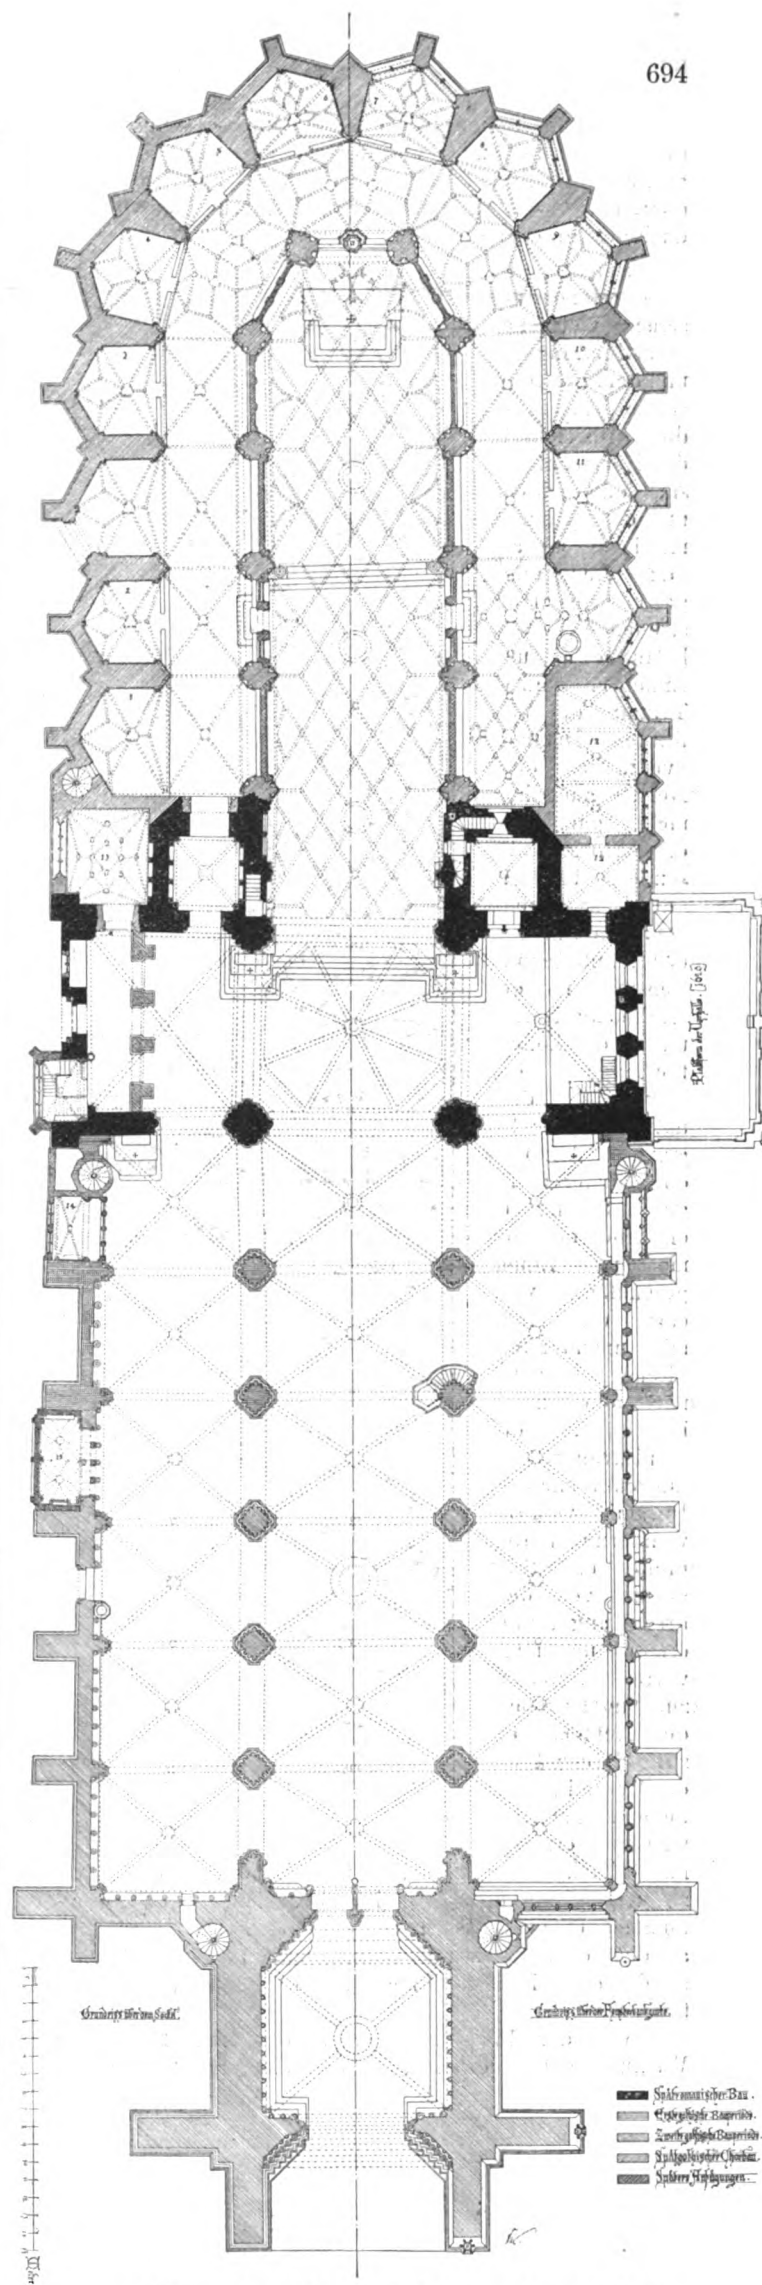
Grundriss des Münsters zu Freiburg i. Br.
